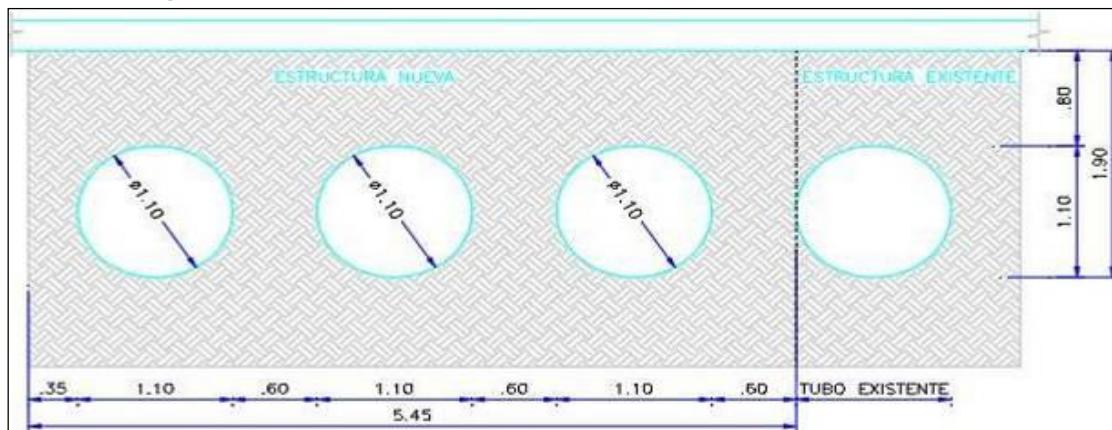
Vista frontal o corte B-B de la obra existente en el PR 84+900
